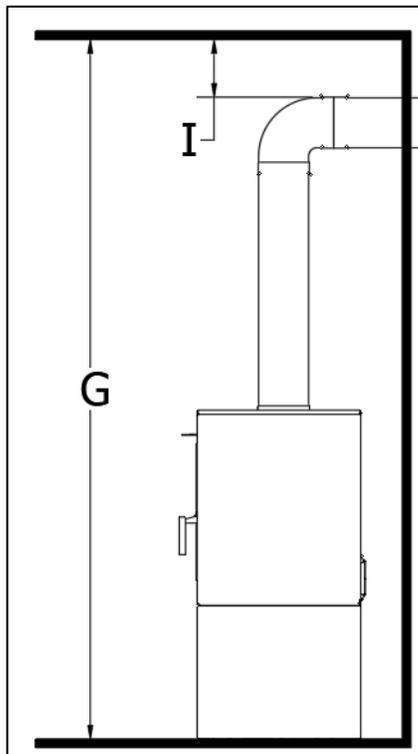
Dégagement aux Combustibles – Installation à Travers Mur
